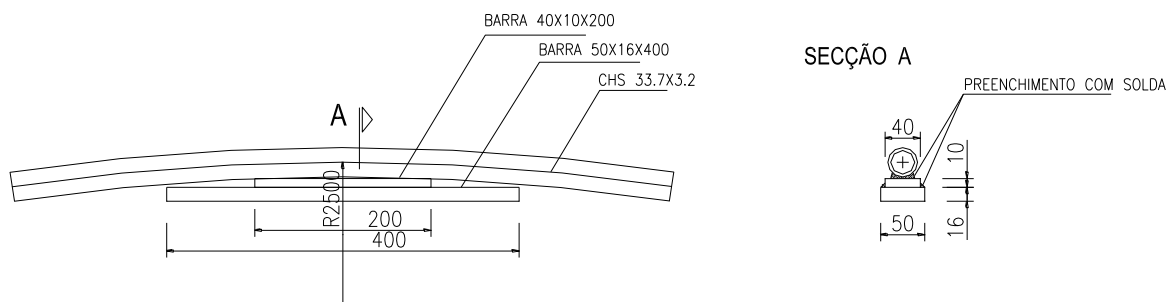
Desenho pormenorizado do desviador usado. (desenho sem escala e com dimensões em mm)
